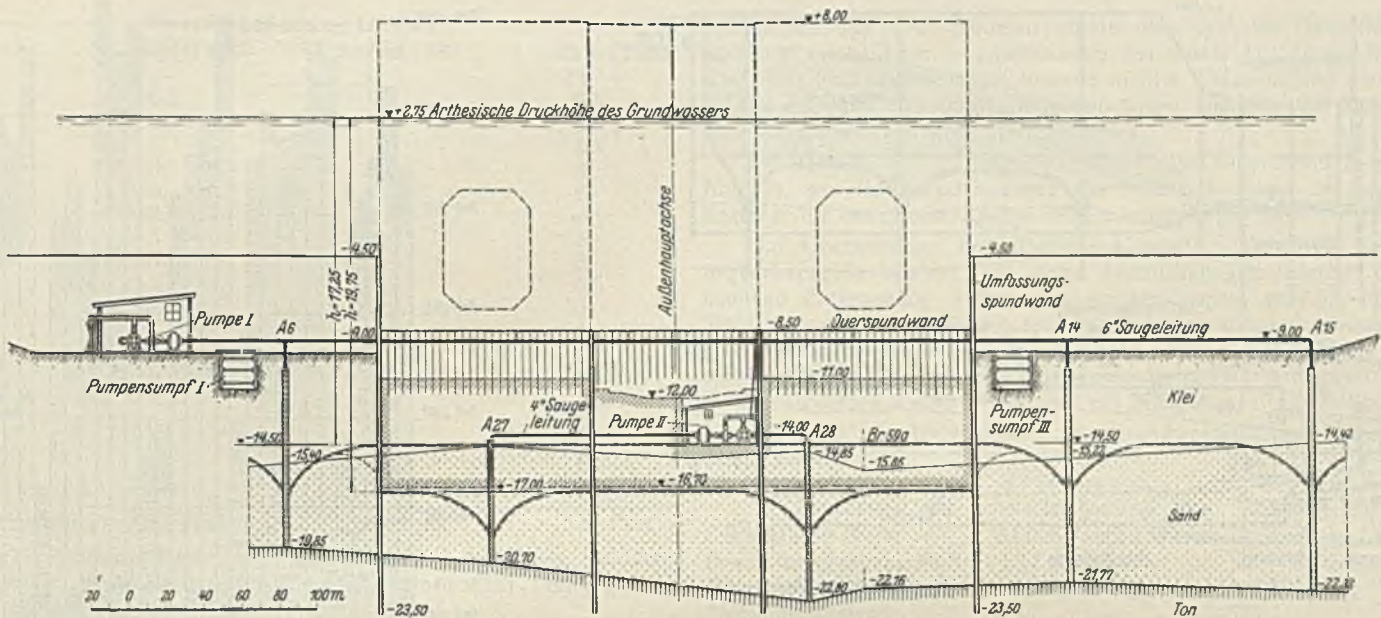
Entwässerungsplan der Nordschleusenanlage.
